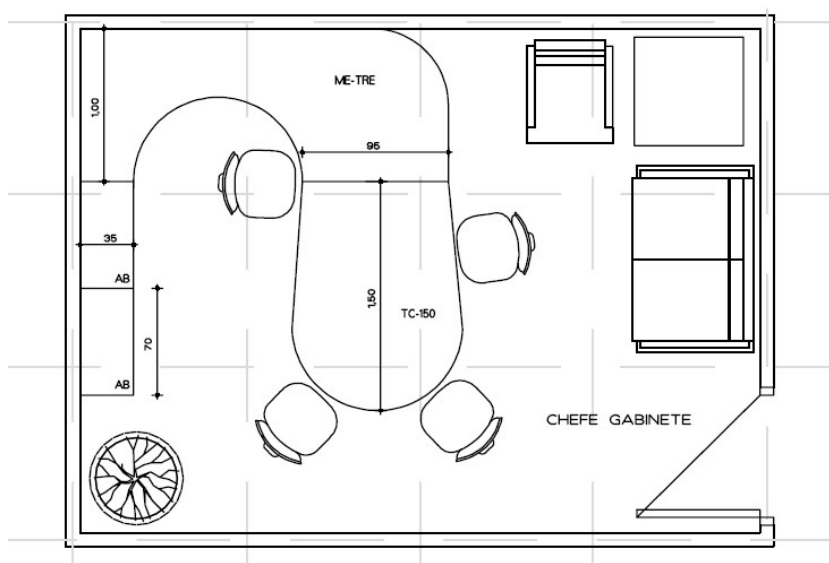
Planta baixa sala chefe de gabinete. Área aproximada: 15m² (Fonte: Plano Diretor do CAFF)
